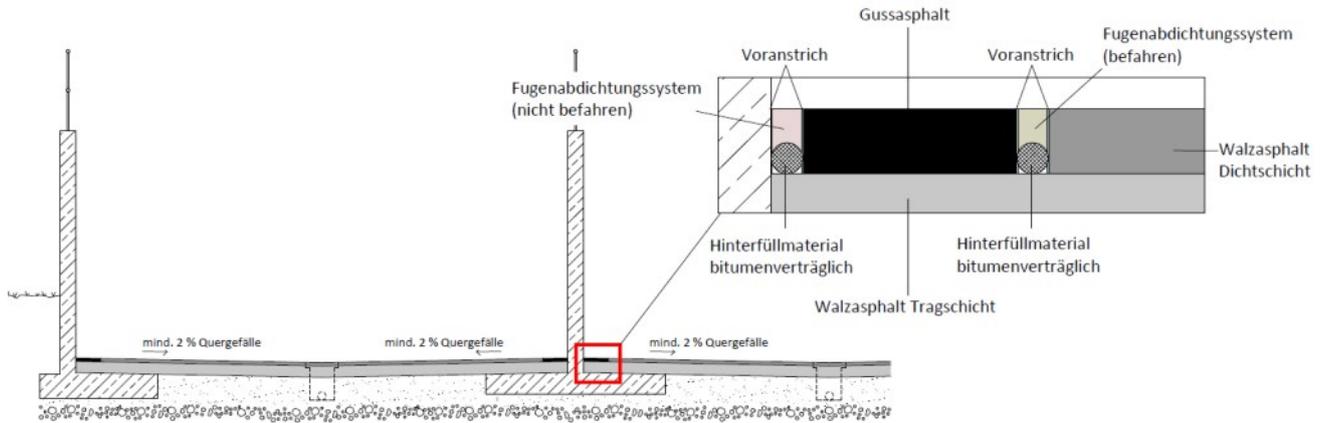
Asphalt - Ortbeton (gerade Wand)
